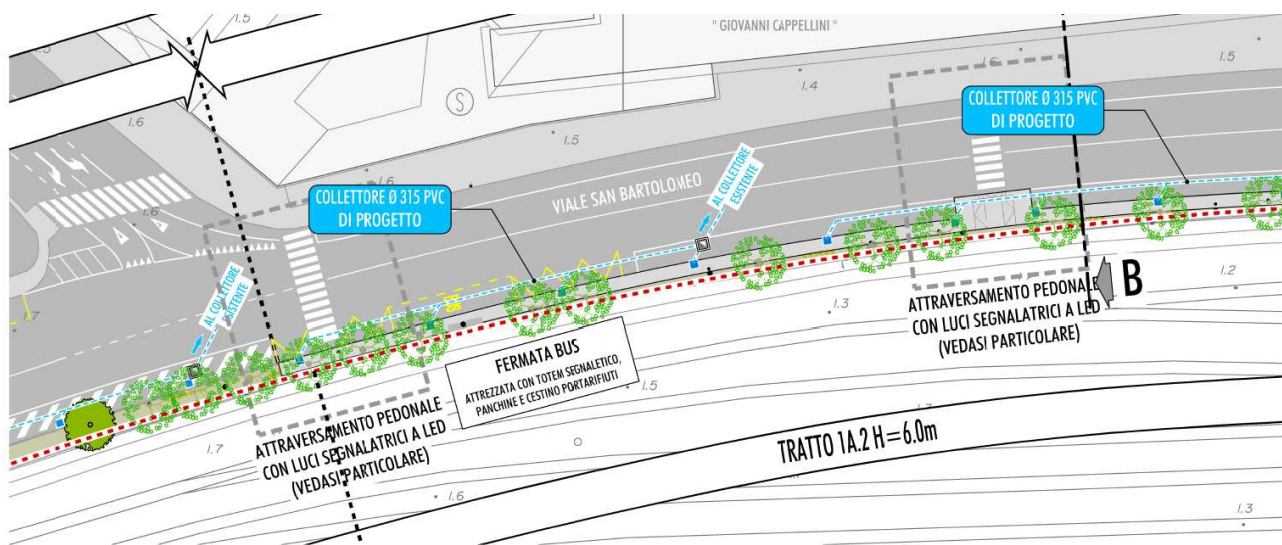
Rete di raccolta delle acque – stralcio planimetrico rappresentativo
